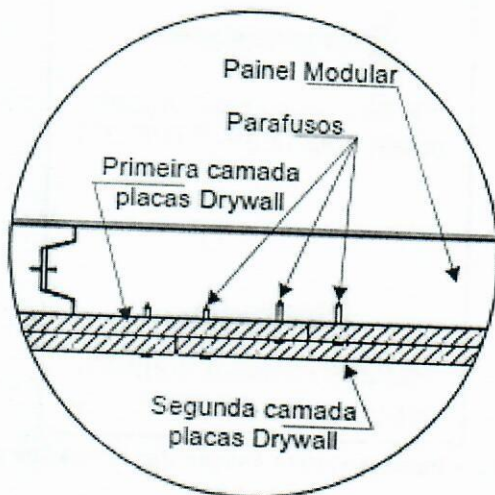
Detalhe da fixação do revestimento duplo de Drywall
